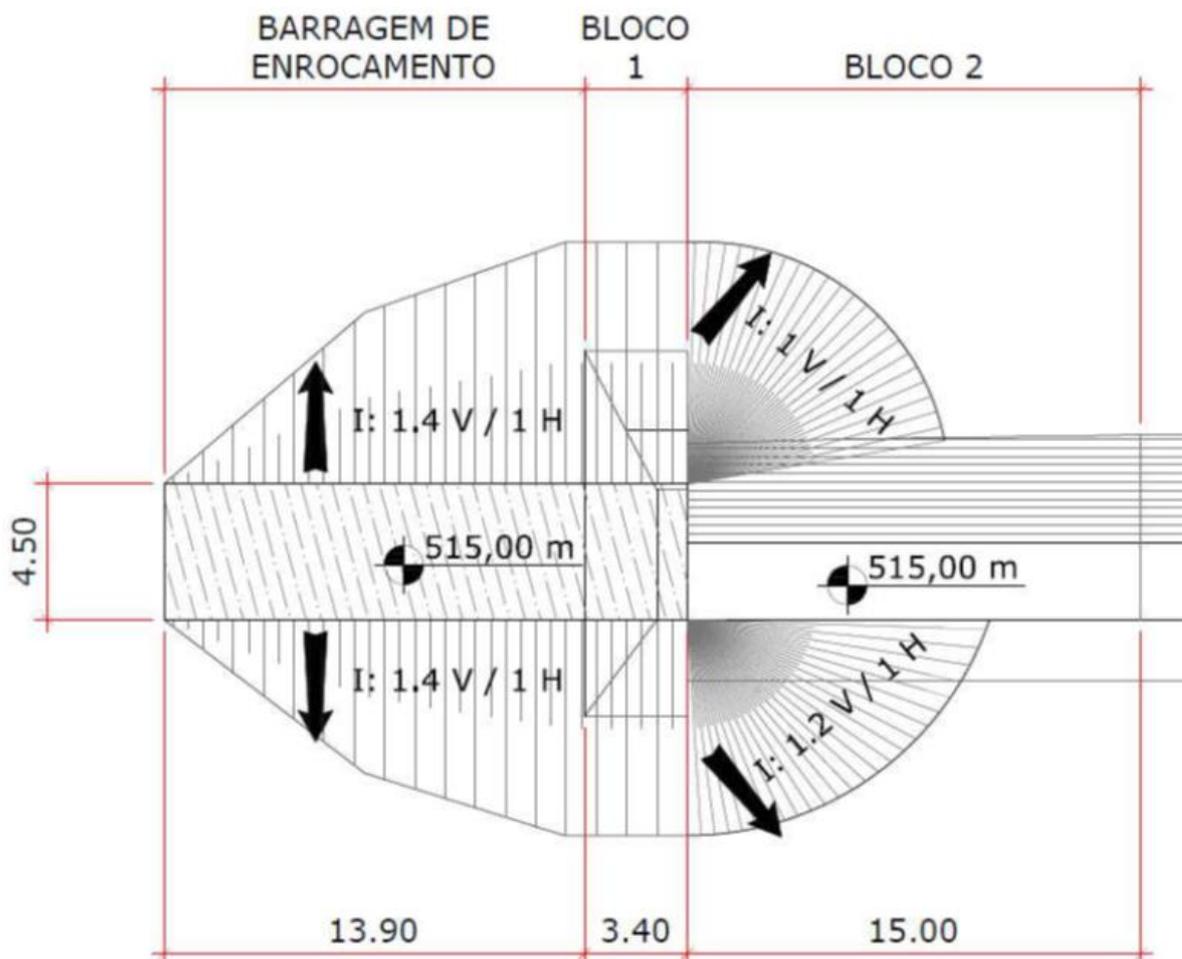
Planta da Barragem Margem Esquerda da PCH Jacaré. Fonte: Enebrás
